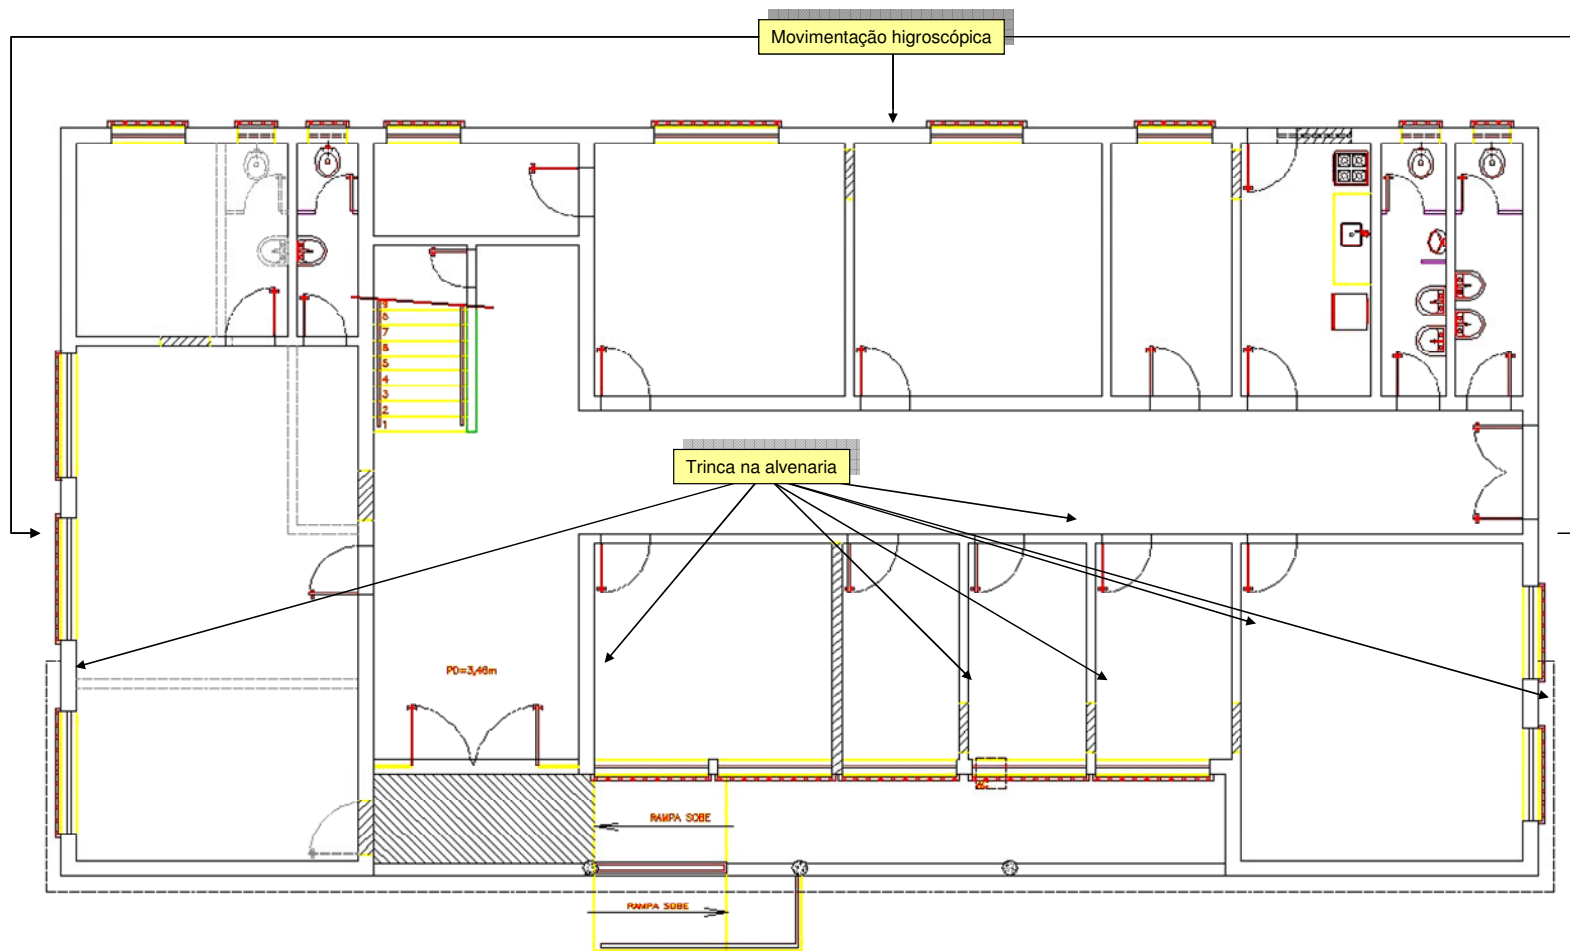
Planta do 1º pavimento e suas patologias.
